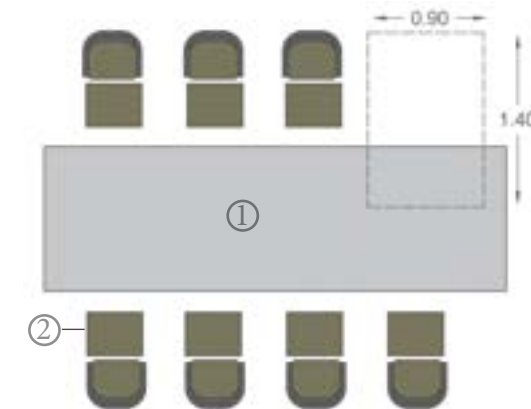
1 Espacio PSdR en mesa - Planta
